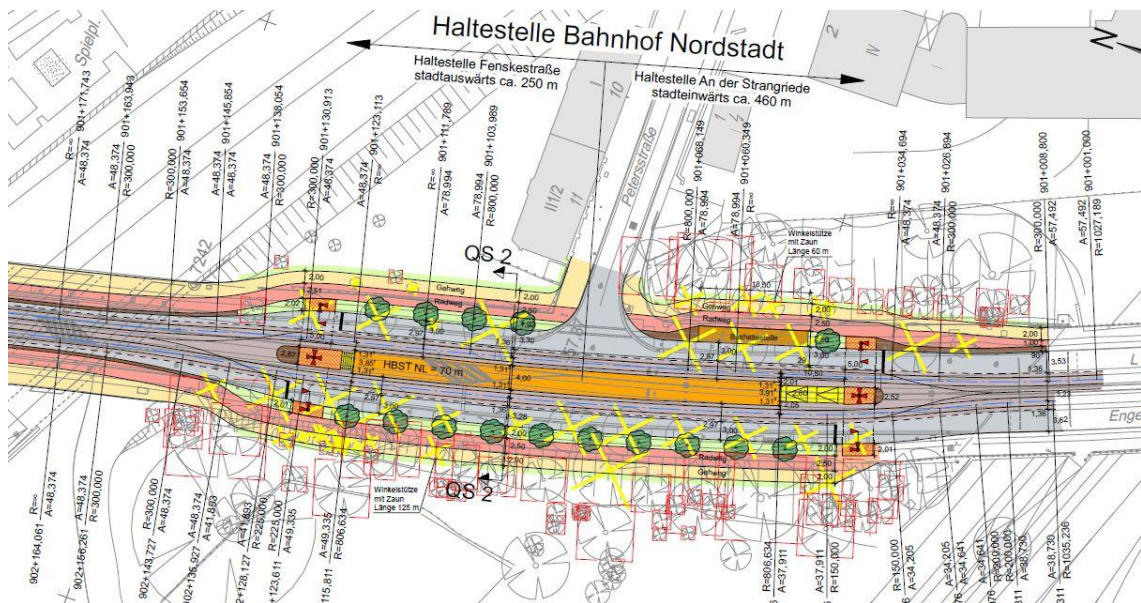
Nordausschnitt aus dem Lageplan Variante 8b
